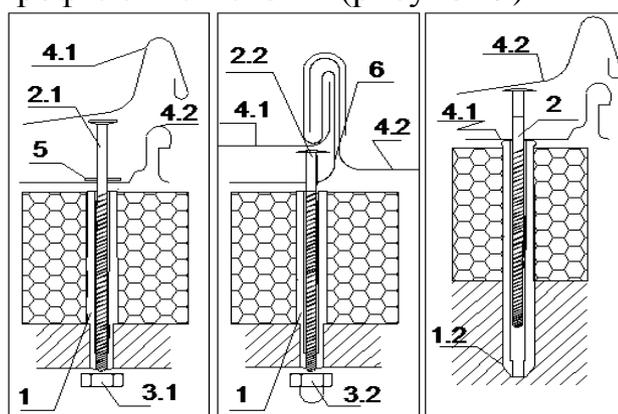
Схема крепления утеплителя на металлические и деревянные стропила:
